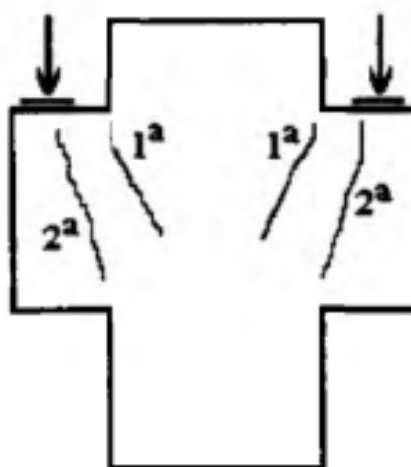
Tipos principais de fissuras observadas nas peças com ruptura por cortante
